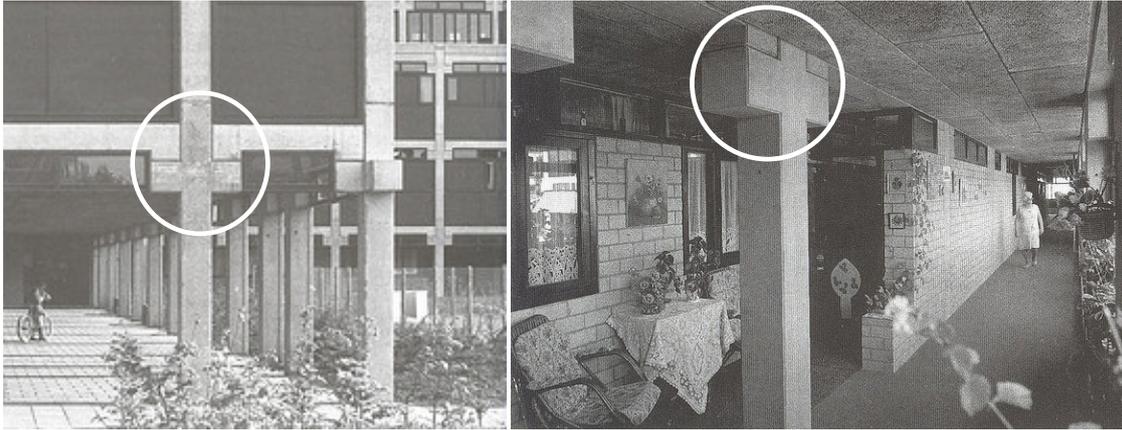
Pormenor do encaixe viga/pilar, exterior e interior.
